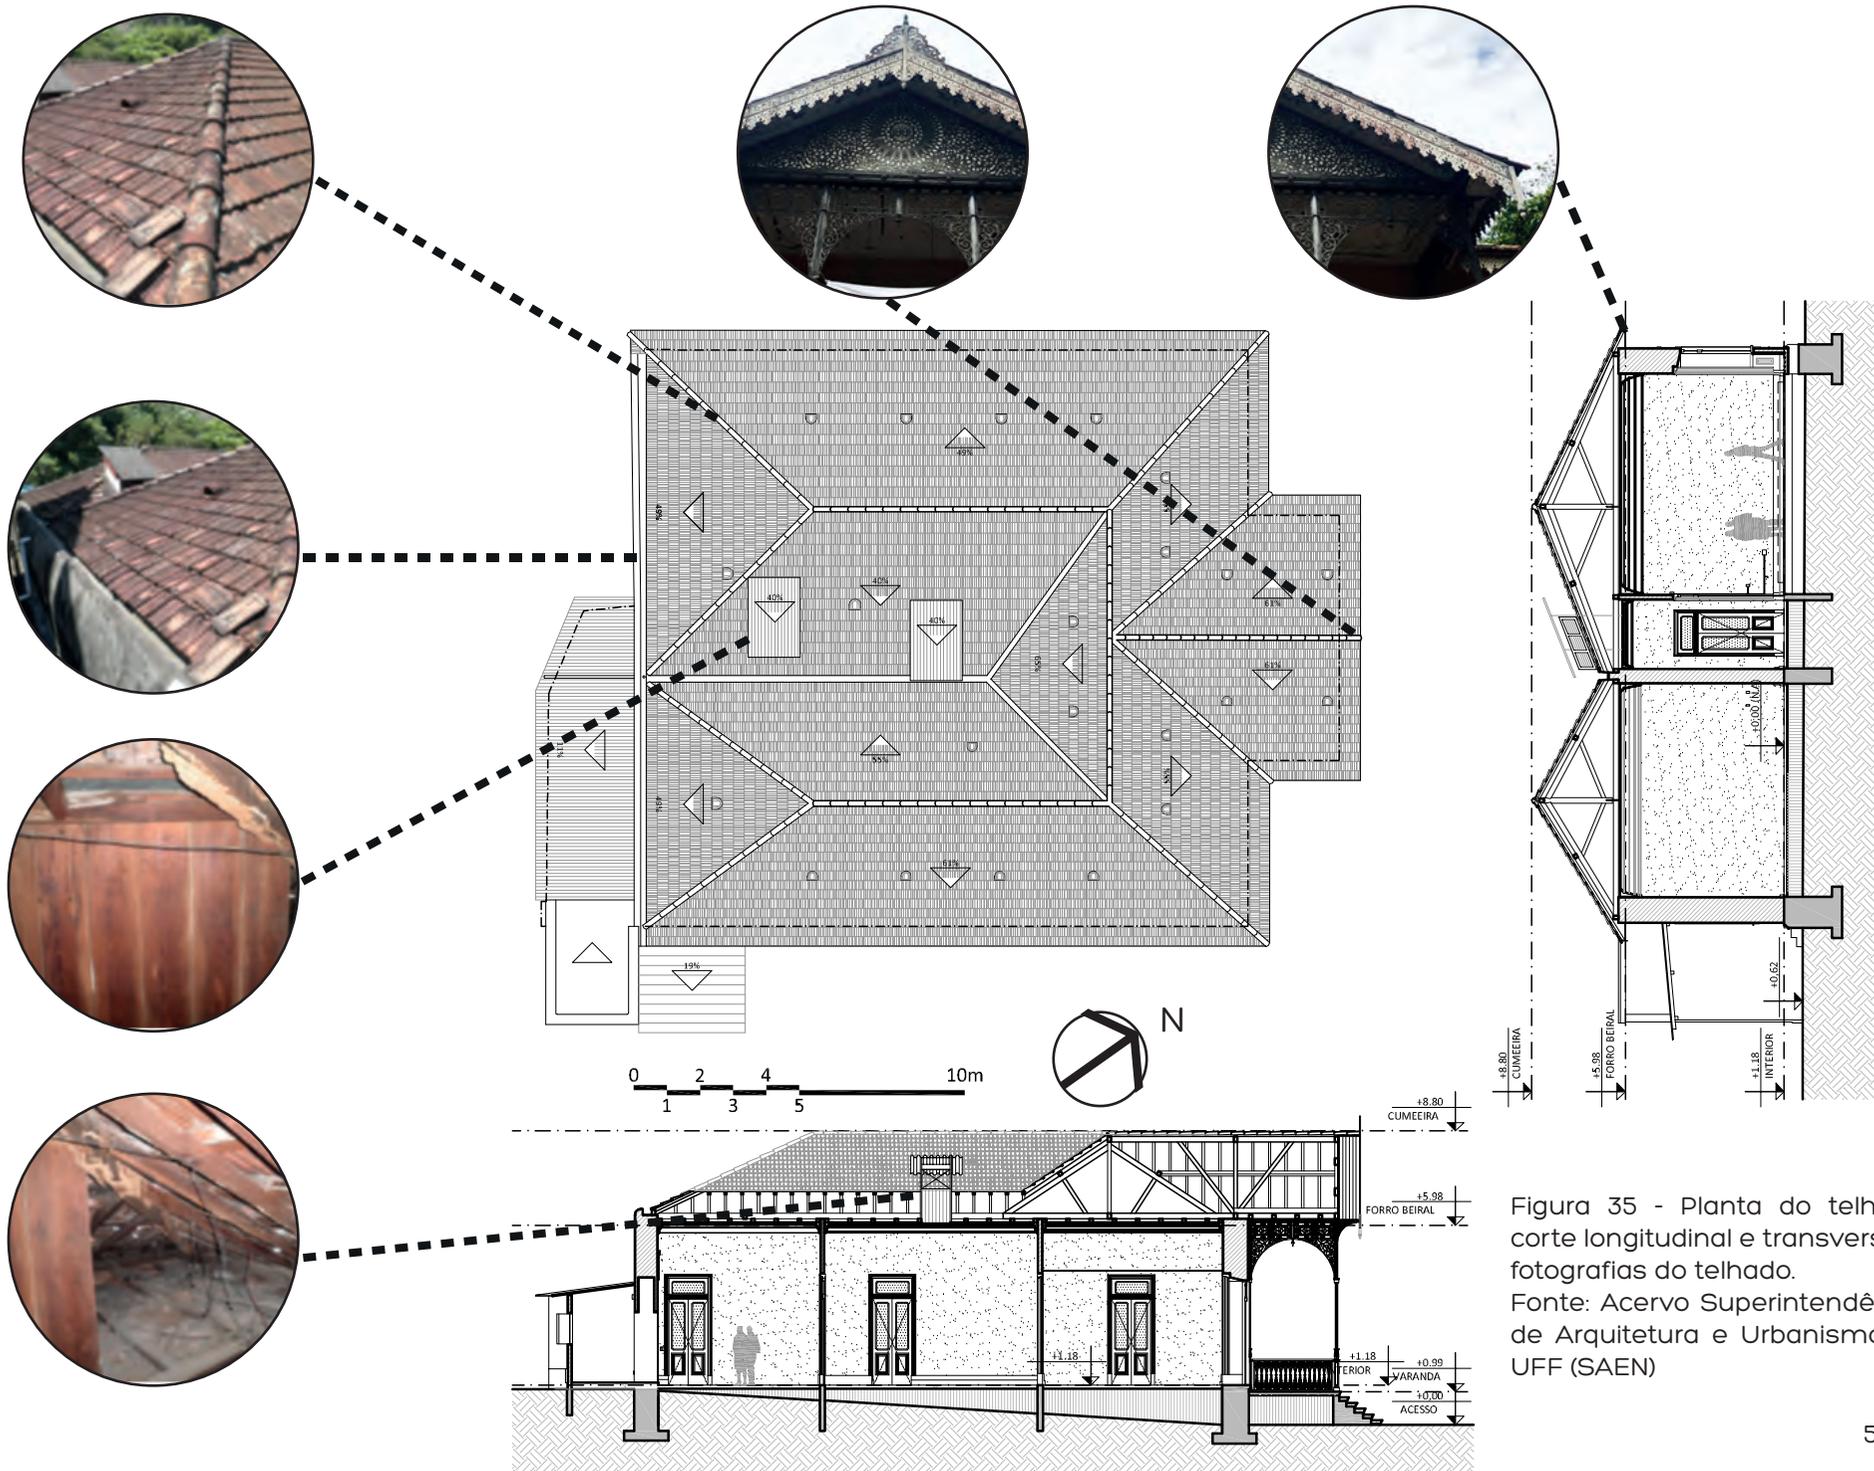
Planta do telhado, corte longitudinal e transversal e fotografias do telhado.
